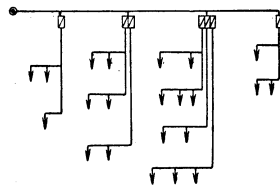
Schaltbild einer Hausinstallationsleitung mit zusammengebauten Sicherungen.
